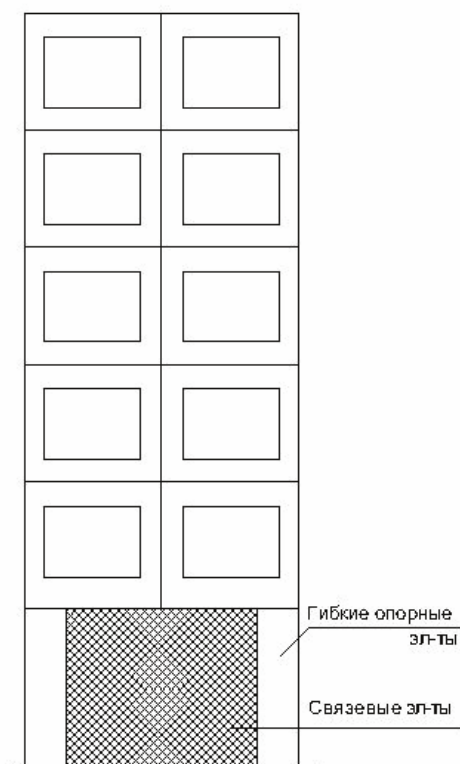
Пример конструктивного решения зданий с выключающимися связями
